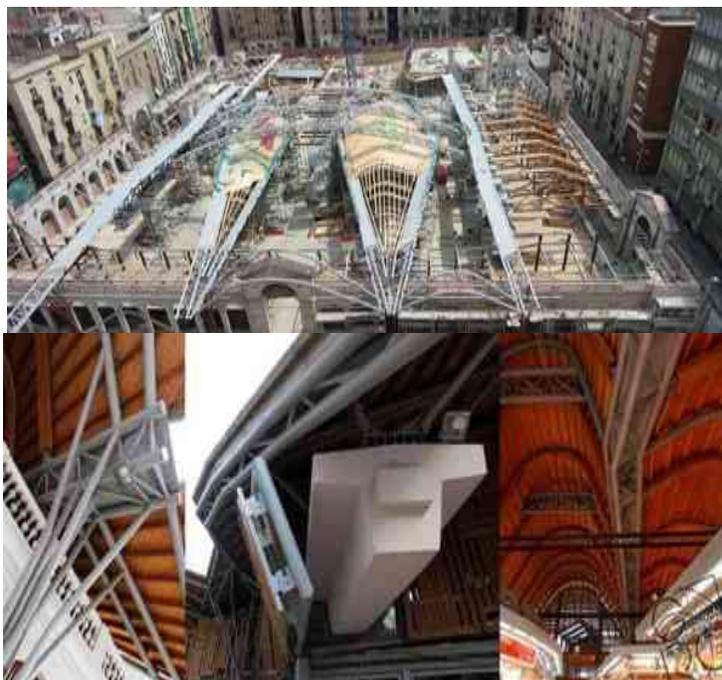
Materiales de construcción que se utilizaron en el mercado. Fuente: UNAV. (s.f.). Recuperado el 19 de Noviembre de 2014, de UNAV: <http://www.unav.edu/documents/29070/371903/aa36.pdf>
